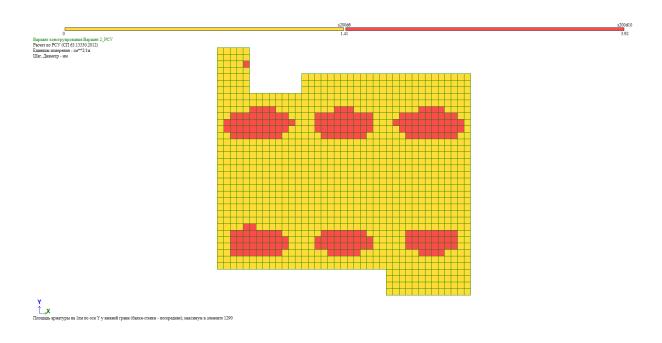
Армирование плиты по оси У (нижняя зона)
